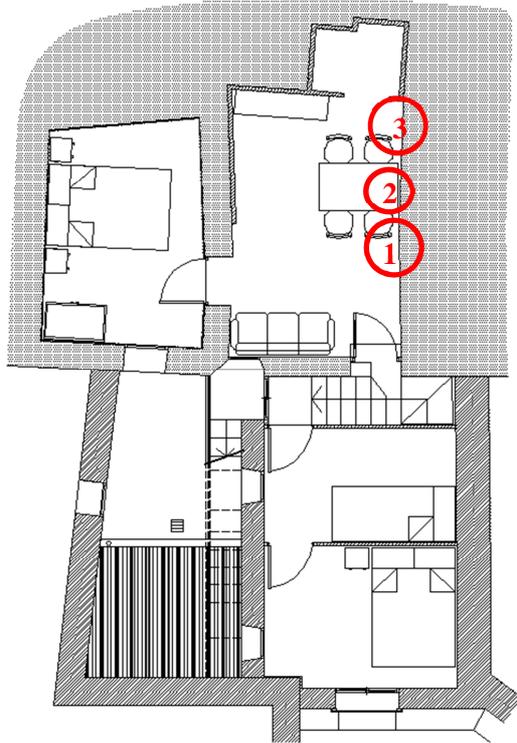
Entreplanta y planta primera. Situación de las manchas de humedad en el salón.
